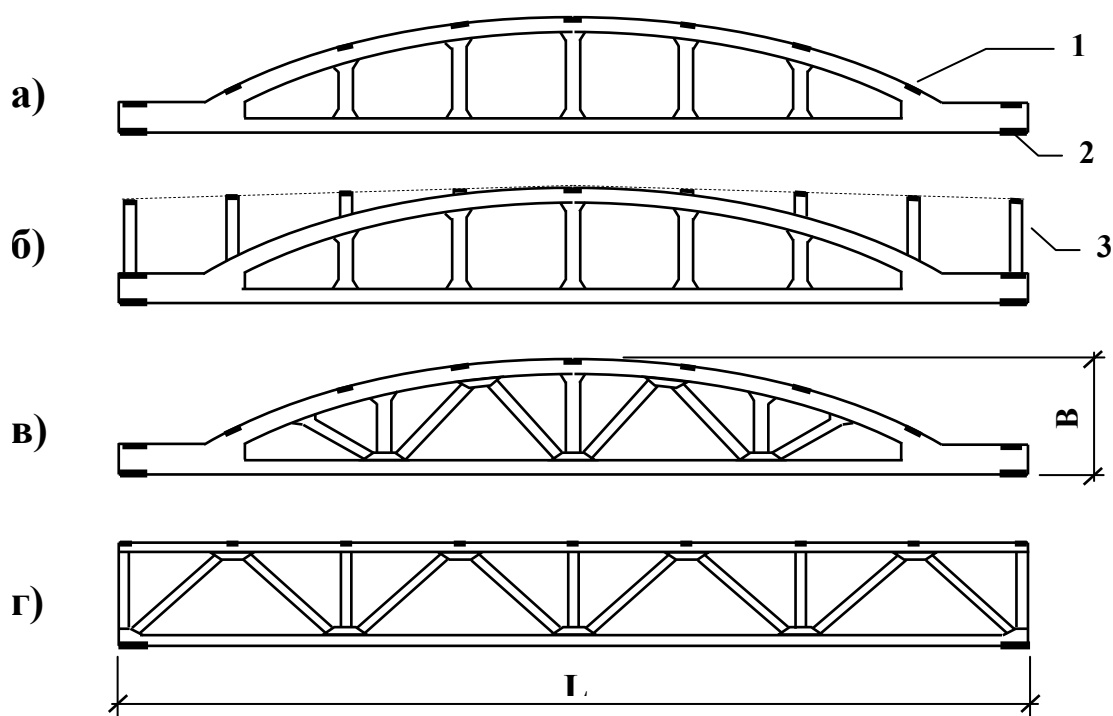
Залізобетонні кроквяні ферми:
